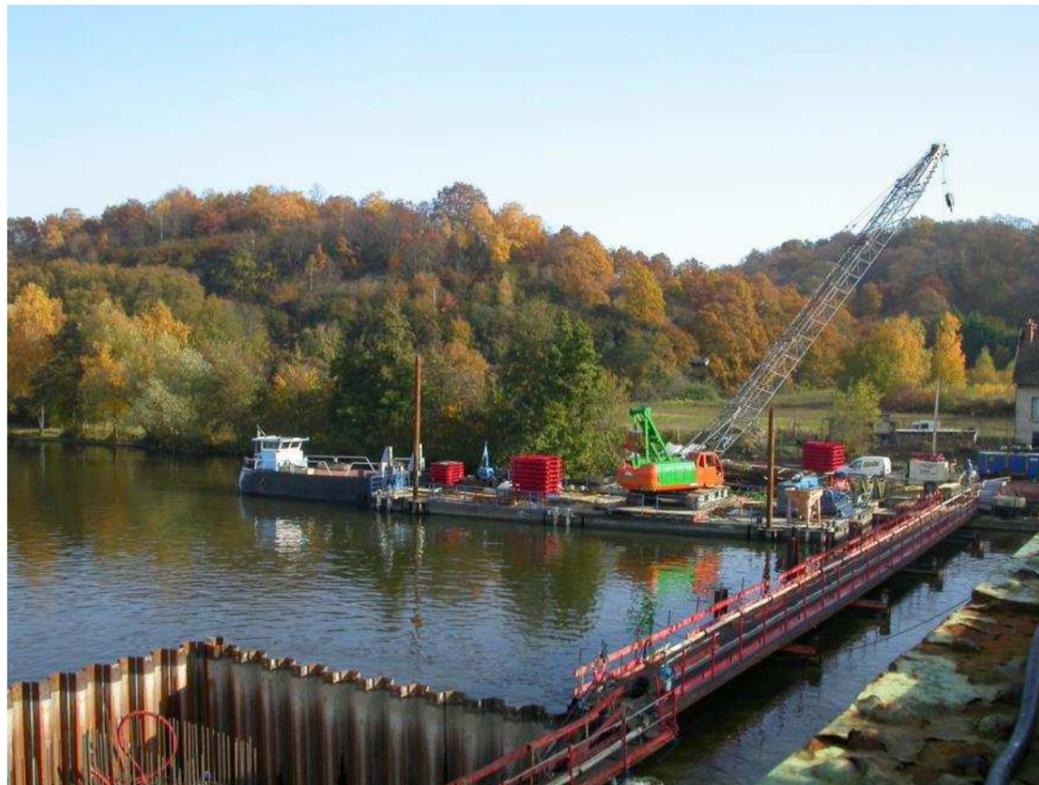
Construction en rivière avec protection en palplanches (source : VNF)
